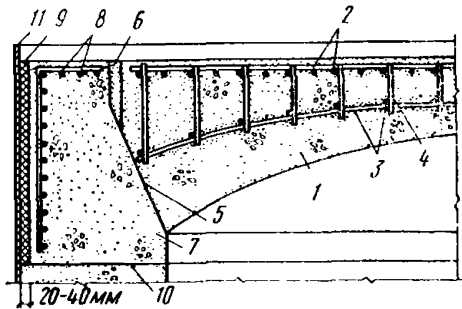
Конструкция железобетонного купола покрытия с плоской верхней поверхностью из жаростойкого бетона для круглого теплового агрегата
